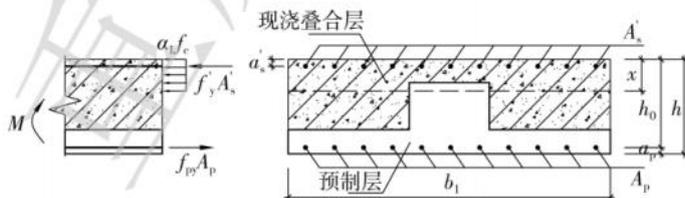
预应力混凝土带肋底板叠合板正弯矩区正截面受弯承载力计算
